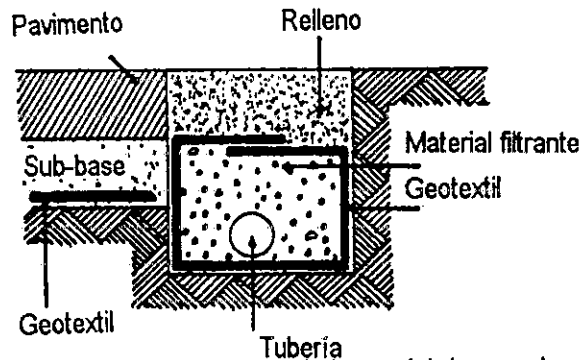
Drenaje de Sub-base (vista en elevación)
